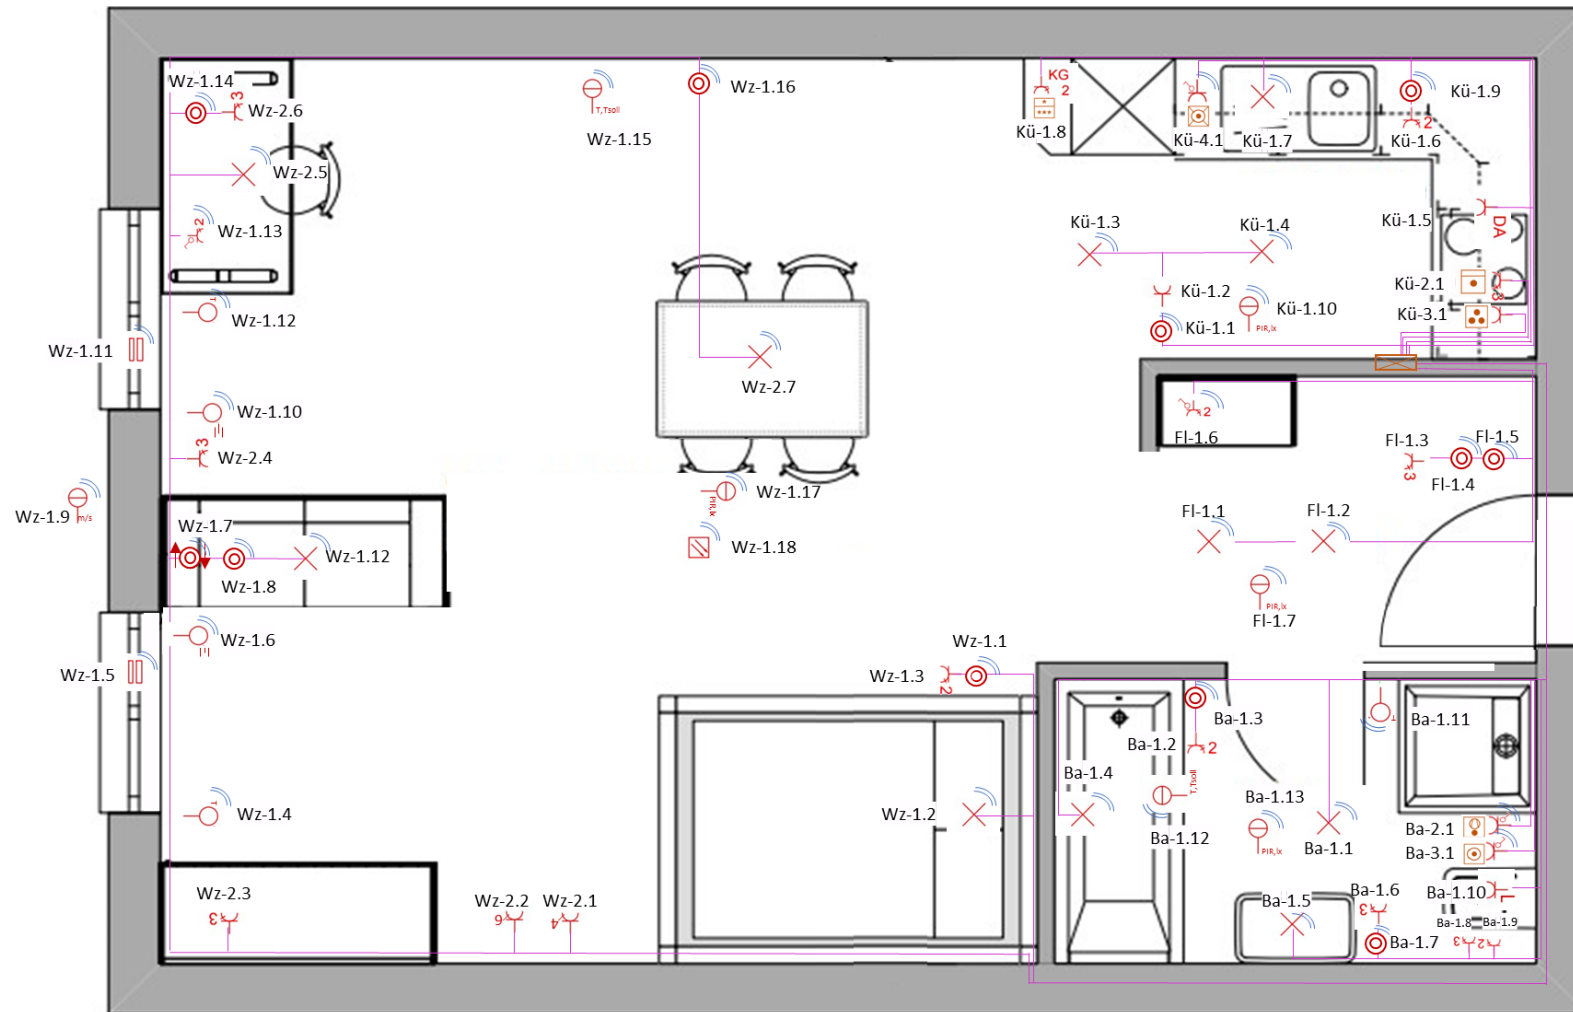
Grundrissplanung, Einzimmerwohnung- EnOcean Technologie- Vollausrüstung
